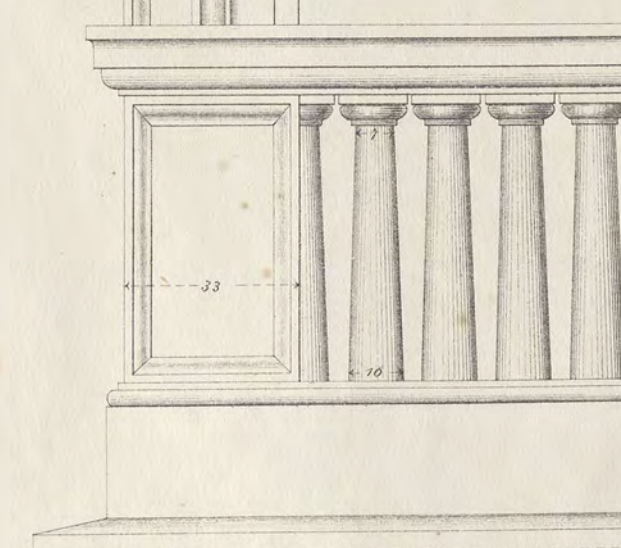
<sup>a</sup> Parapetto della finestra del primo piano.
